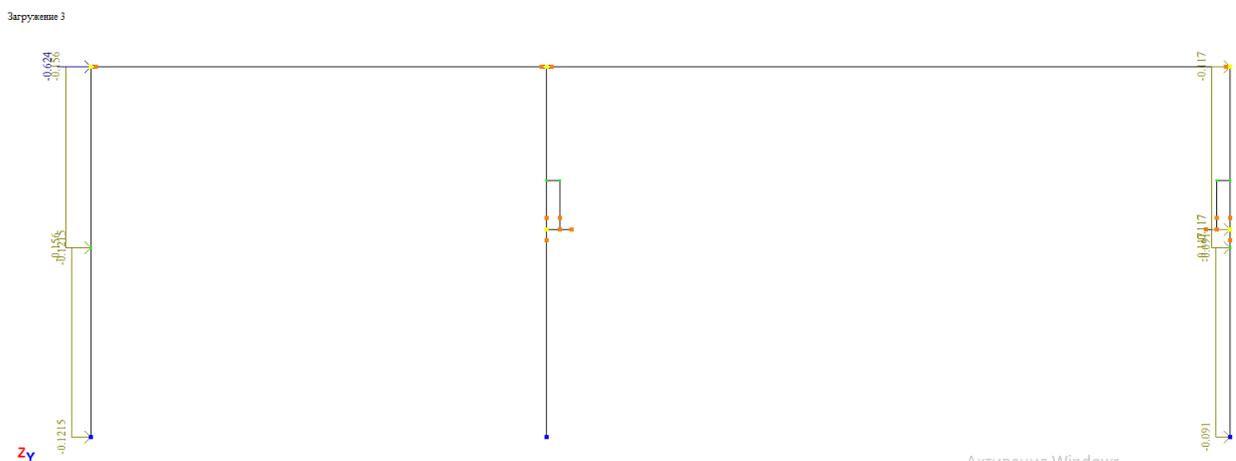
Загрузка рамы ветровой нагрузкой слева направо
